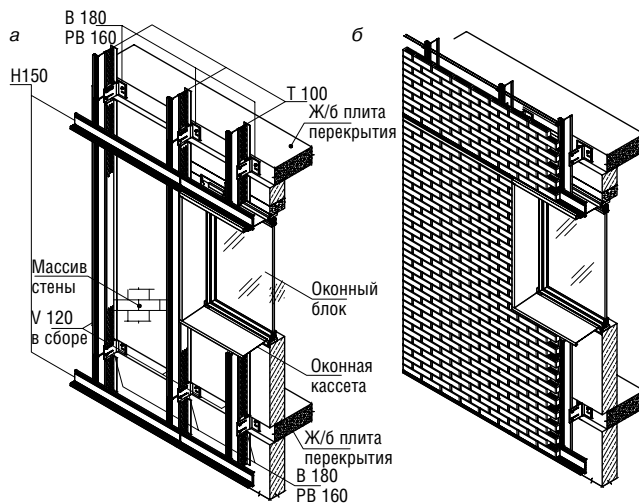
Конструктивная схема навесного фасада из каменной кладки: а — установка горизонтальных направляющих; б — фасадная система с облицовкой кирпичом
